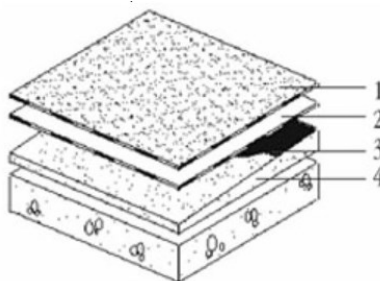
Pormenorização das diferentes camadas do sistema de impermeabilização [13].
